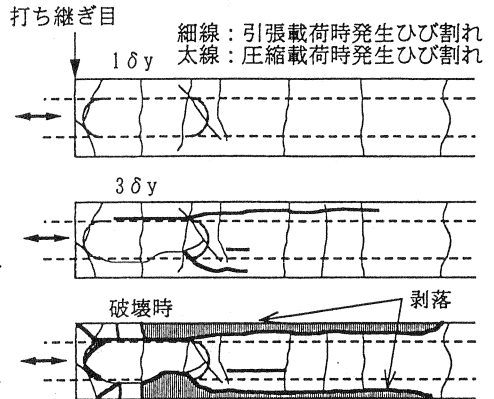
ひび割れ図 (CASE-5 供試体)
